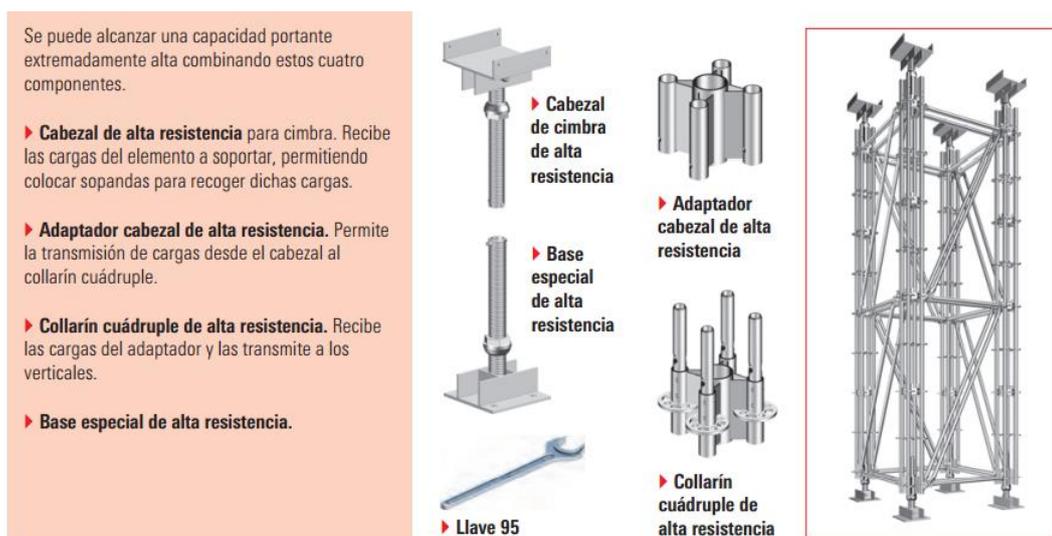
Ejemplo de configuración de 4 tubos por pata para cimbra de GRAN CARGA sistema Allround.
